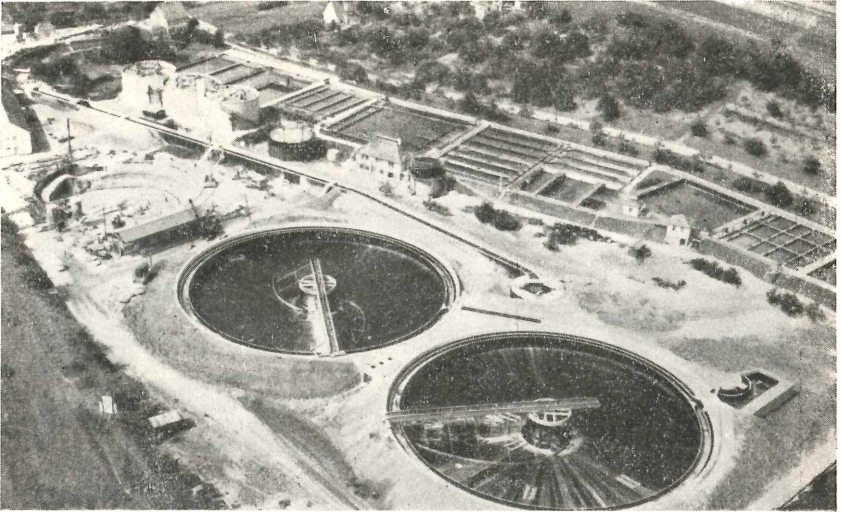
Kläranlage Stuttgart-Mühlhausen
